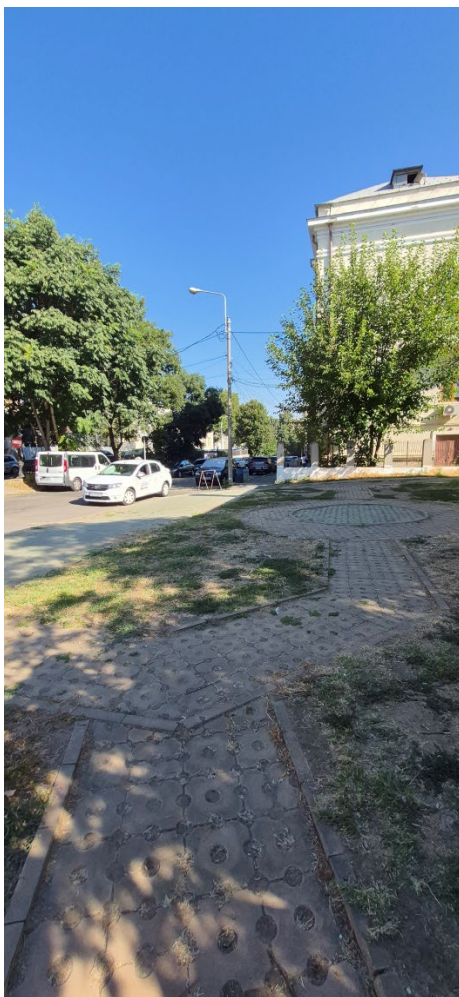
Alei pietonale – detaliu al pavajului existent.
